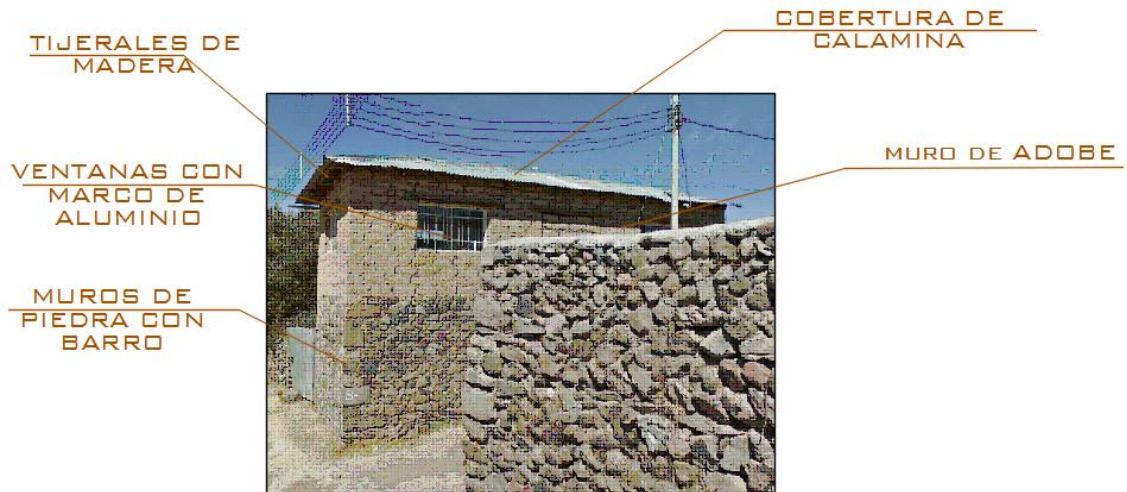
Sistema Constructivo de Viviendas de Piedra con Cemento
